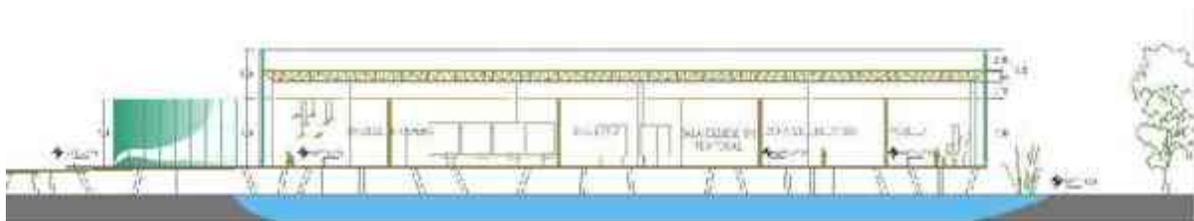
Corte transversal del proyecto, se muestran las columnas que suspenden al edificio sobre el terreno
